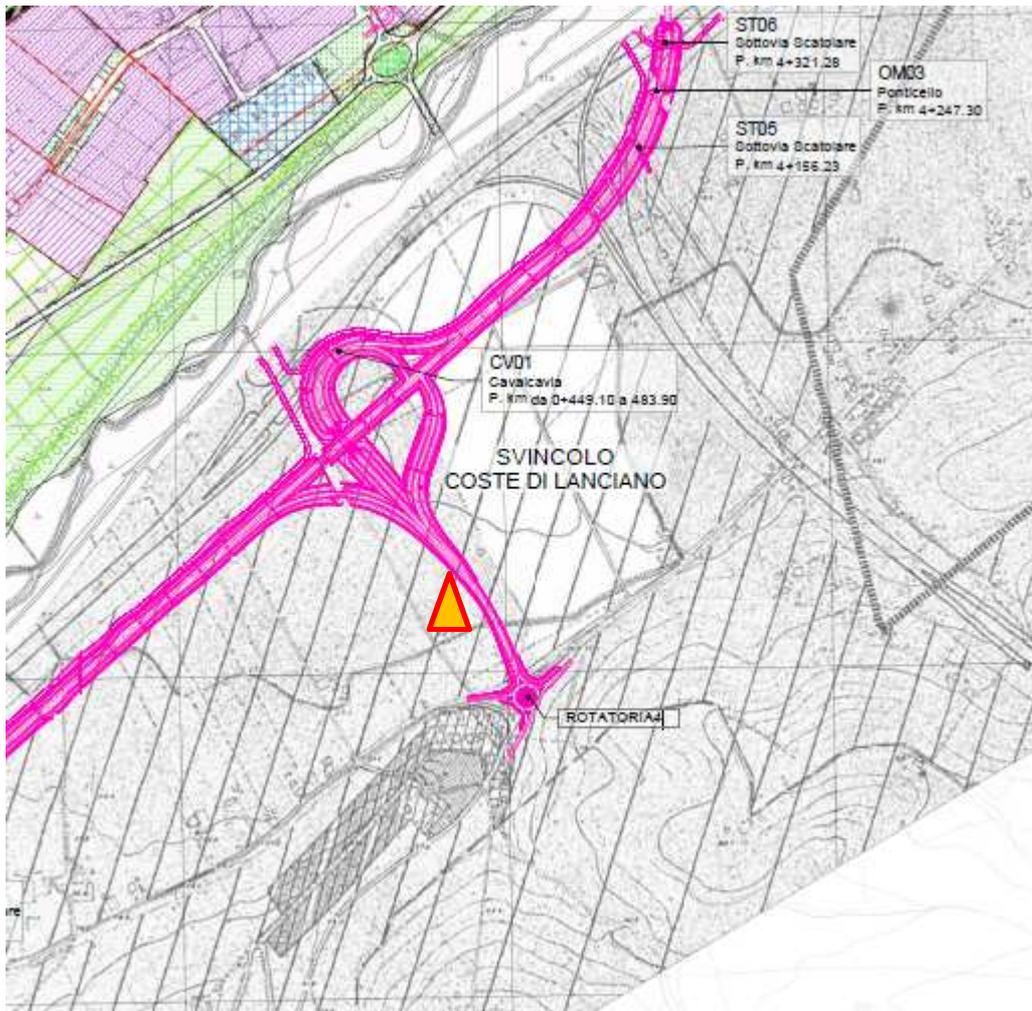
Dettaglio sovrapposizione Area Cantiere Logistico CL04
